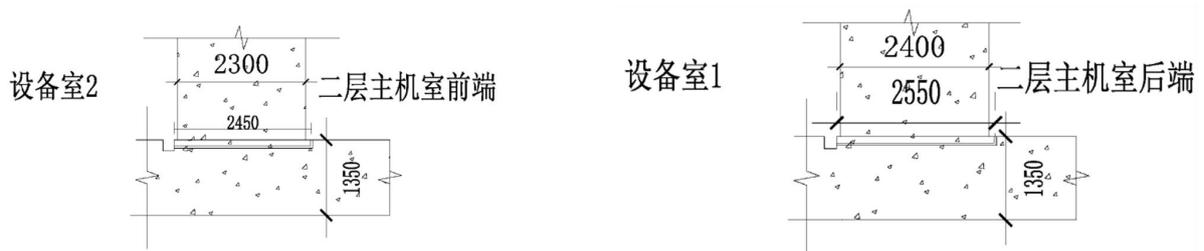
本项目电缆管线穿墙示意图 (单位 mm)
